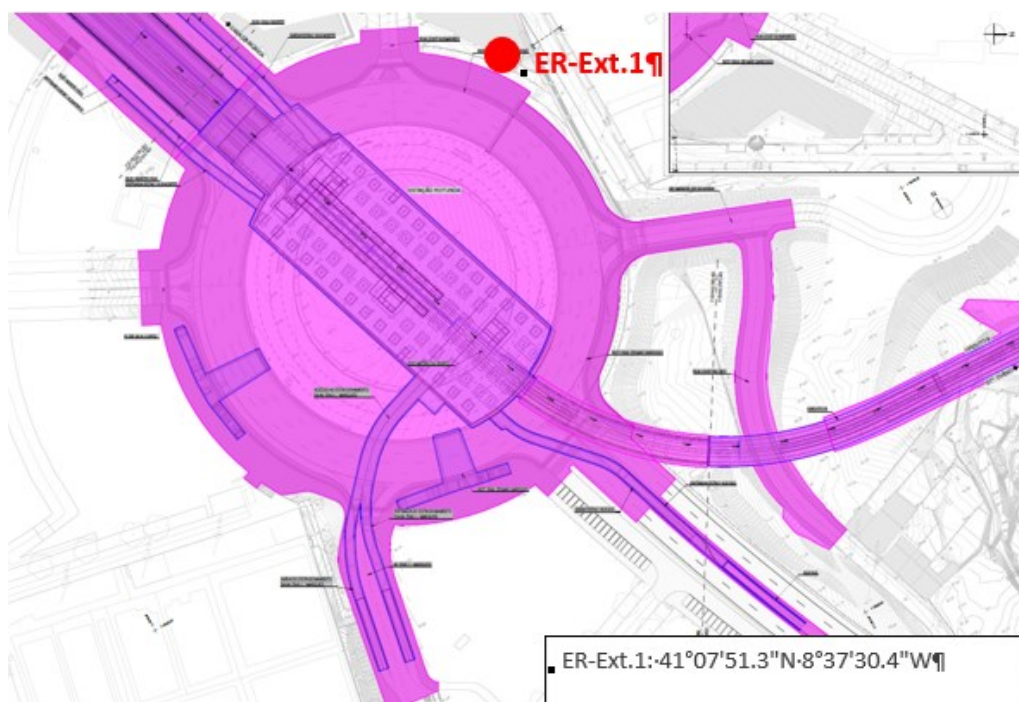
Pontos de monitorização junto Estação Rotunda (ruído – construção)
